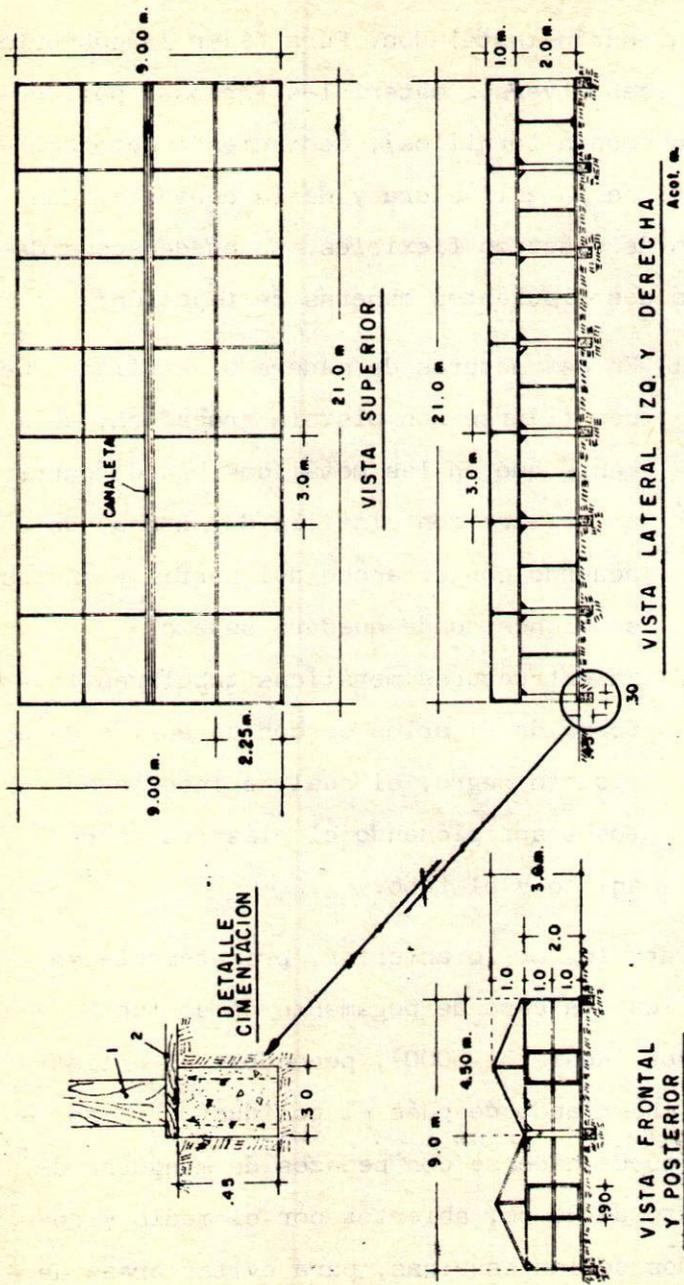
Detalles de construcción para un invernadero con estructura de madera.
